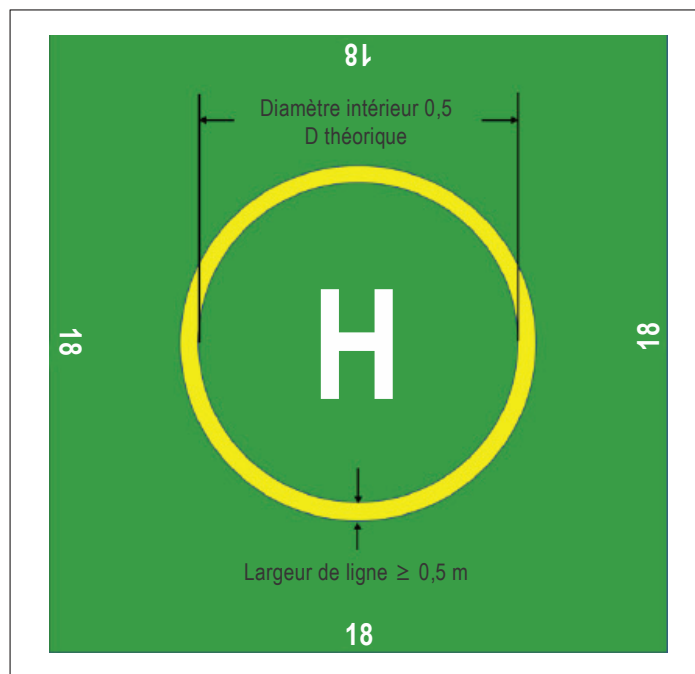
Dimensions du cercle de la marque de prise de contact ou de positionnement (TDPC)
